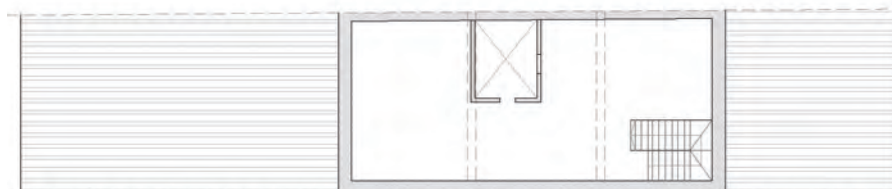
9. PLANTA BAJOCUBIERTA
